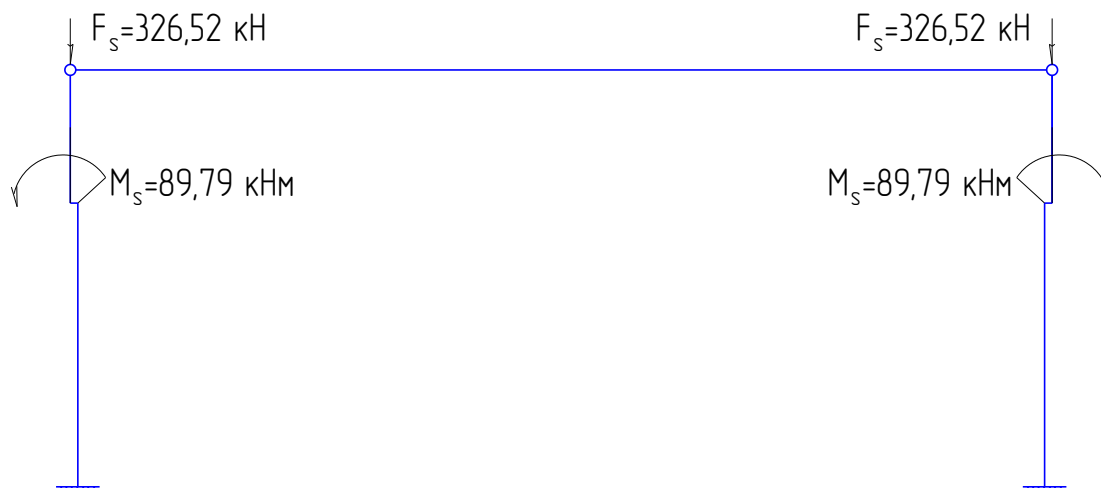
Расчетная схема поперечной рамы на снеговую нагрузку
